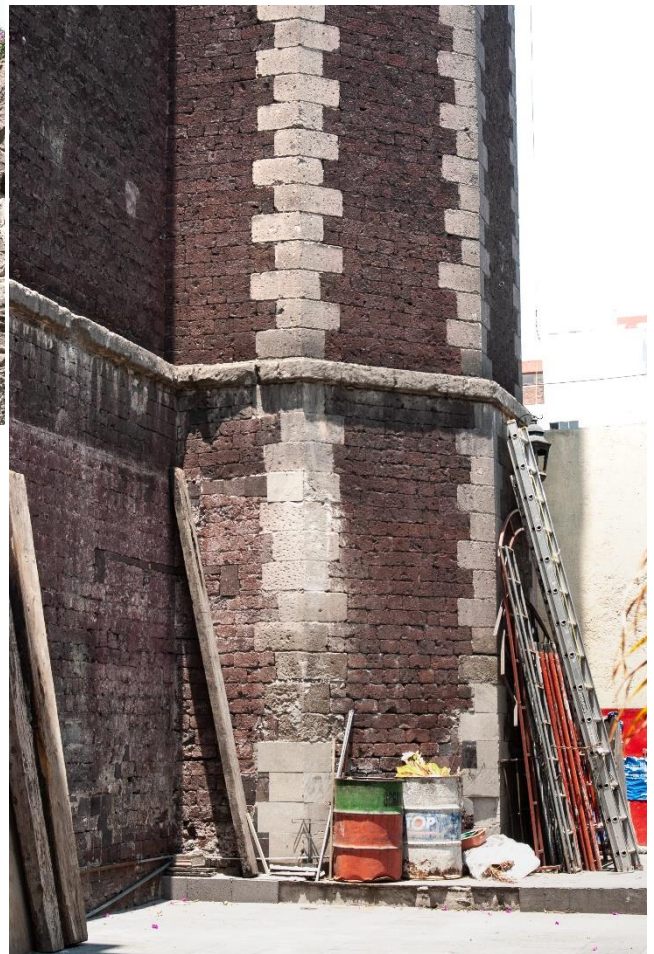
Detalle del aplanado del interior de la torre norte (fotografía: Brian Nolasco, 2018).
